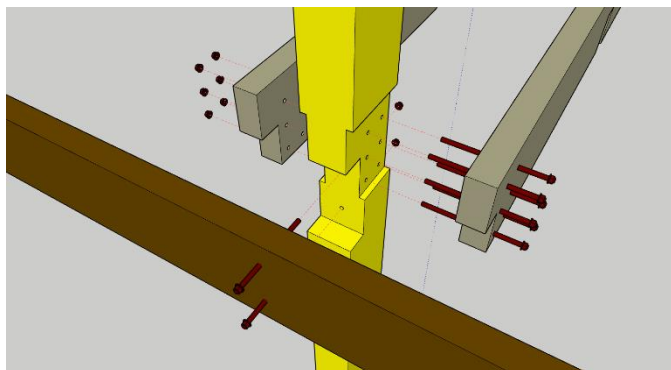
Узел крепления к колонне обвязочных балок и балок покрытия
